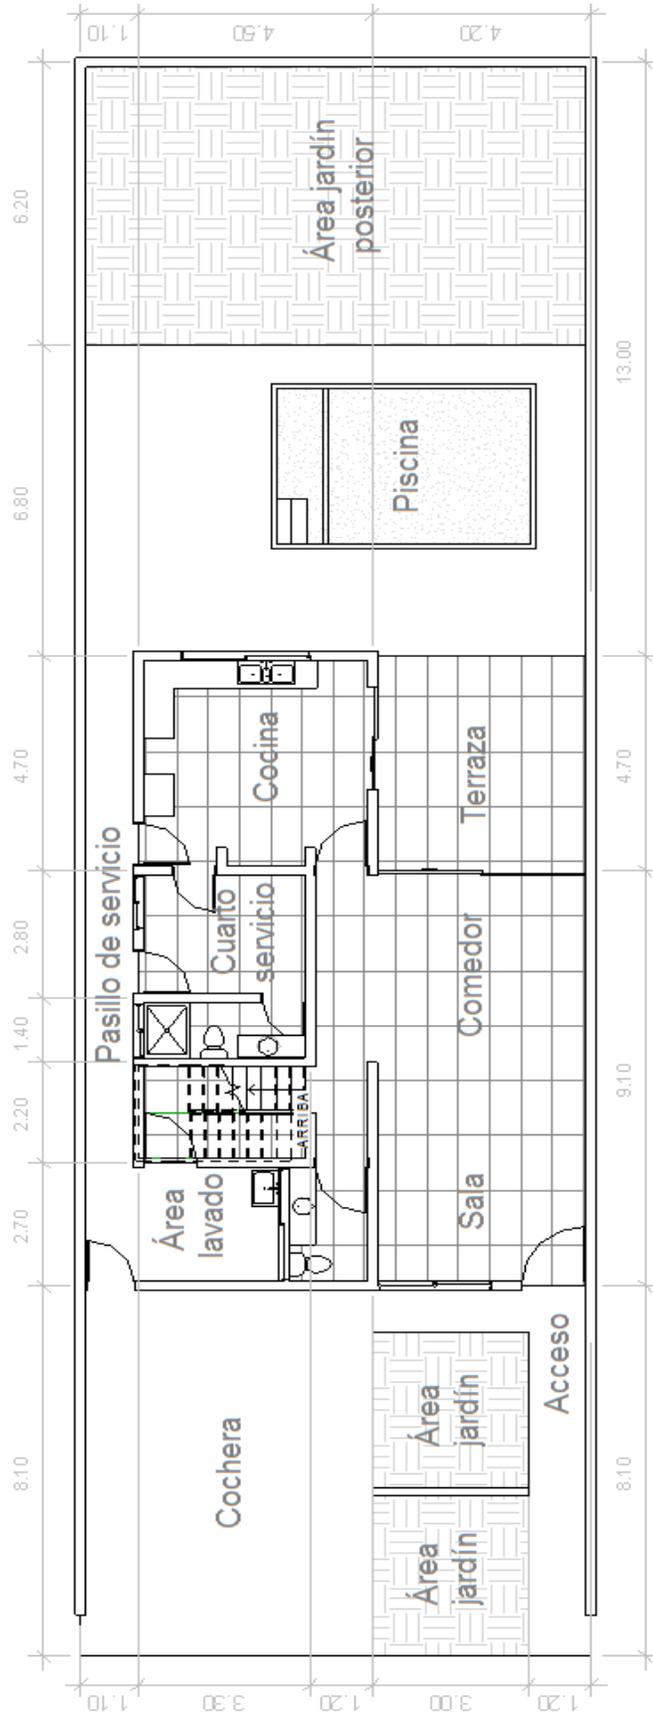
Croquis de planta baja de vivienda tipo residencial plus
